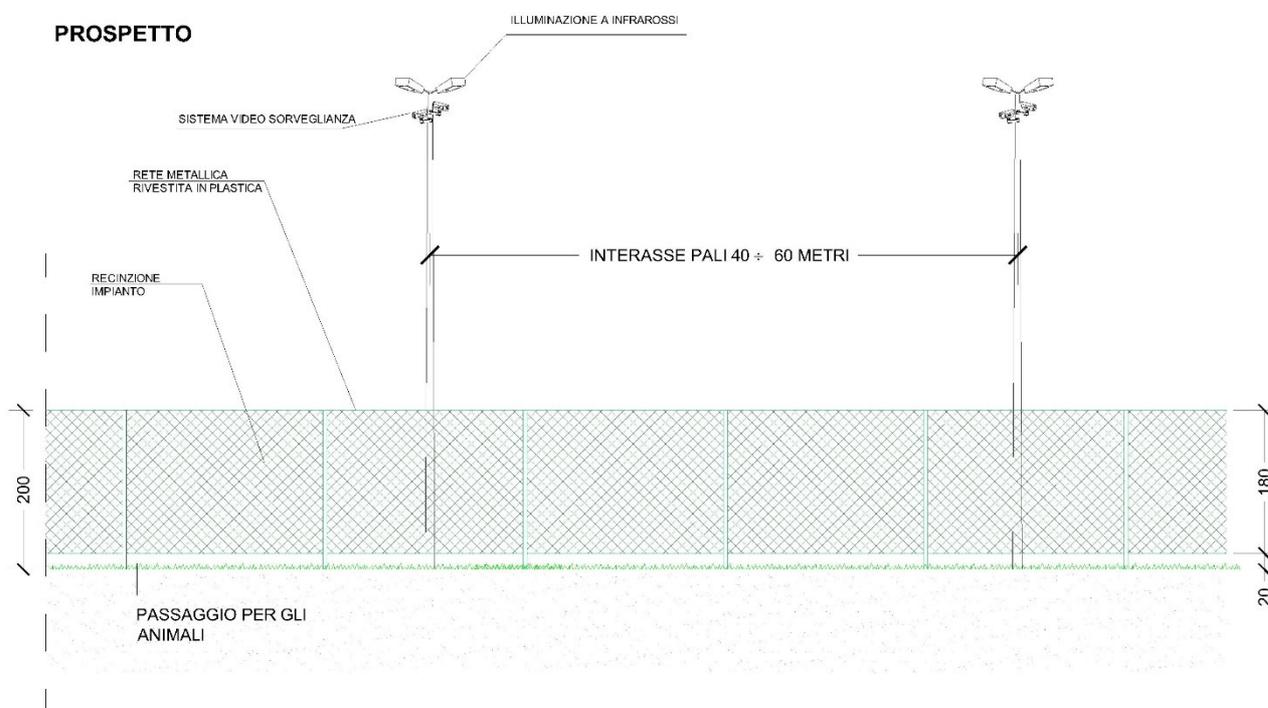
Prospetto sistema illuminazione/videosorveglianza.
